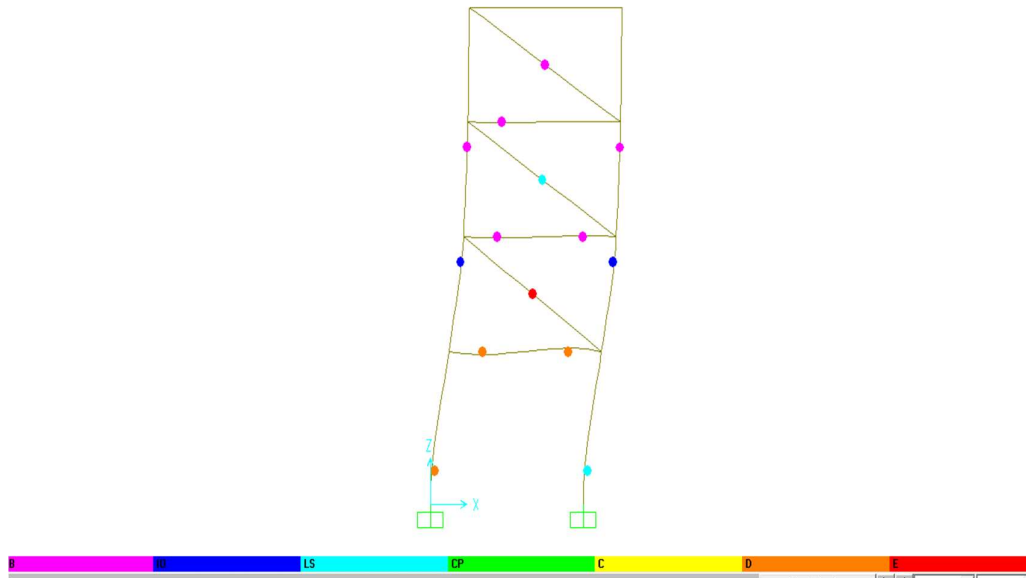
Mecanismo de falla en pórtico de hormigón armado relleno con mampostería del modelo 5M-B.
